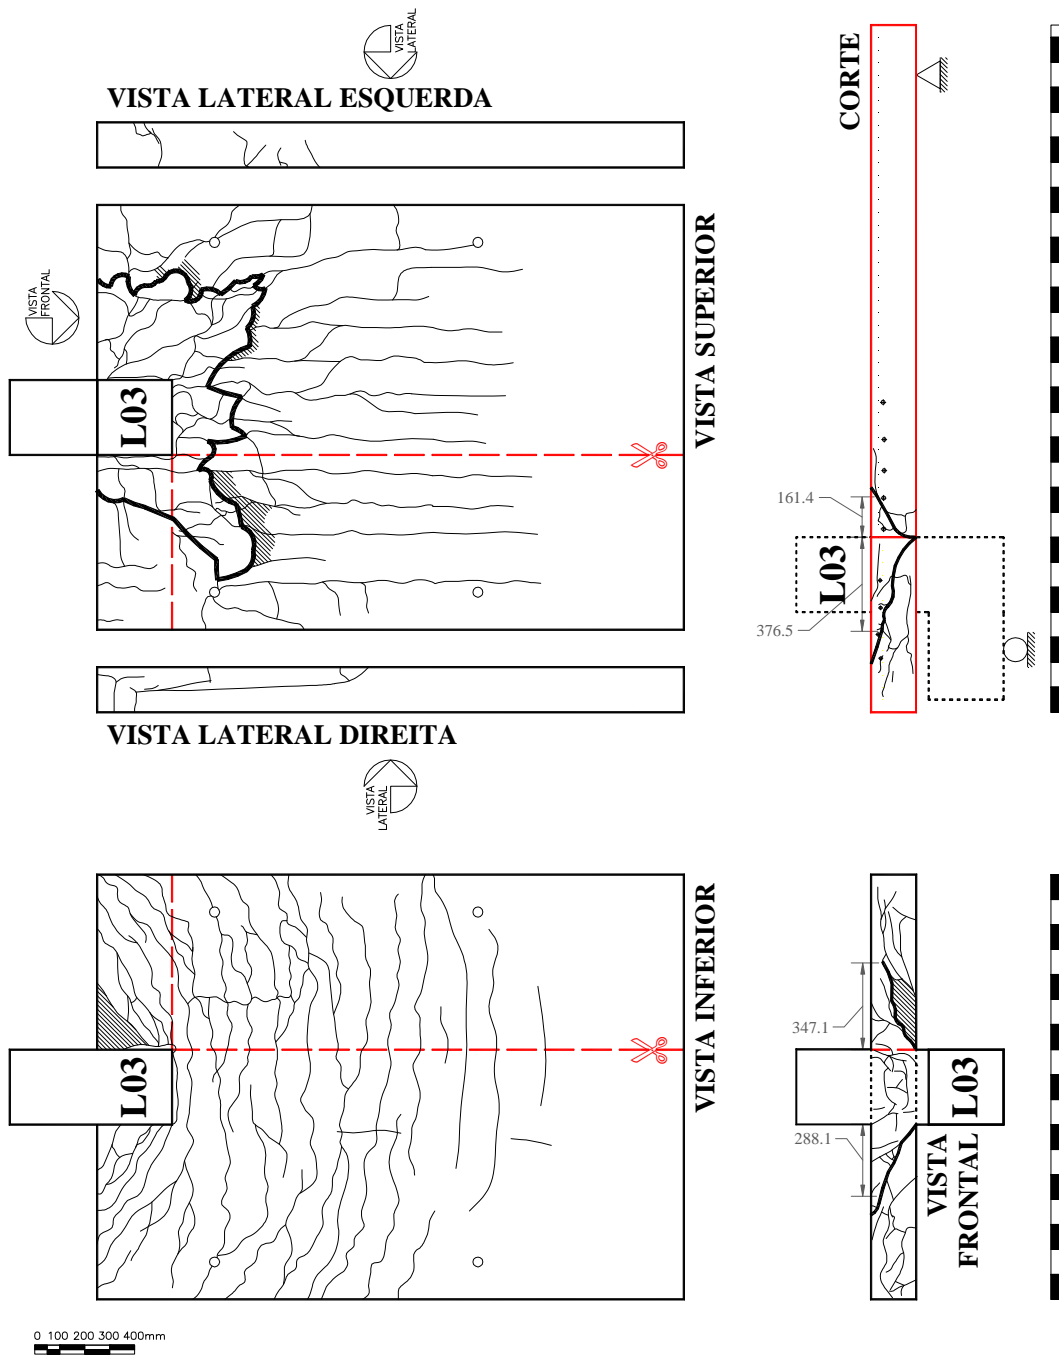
Padrão de fissuração da laje L03
